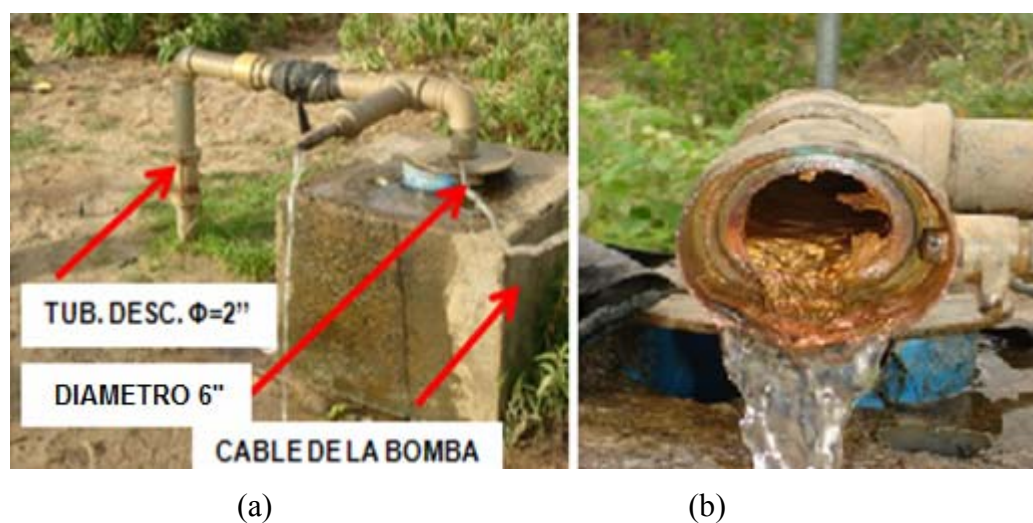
Detalles del Pozo Pilón N° 2. (a) Estructura Externa, (b) Tubería de Descarga.
